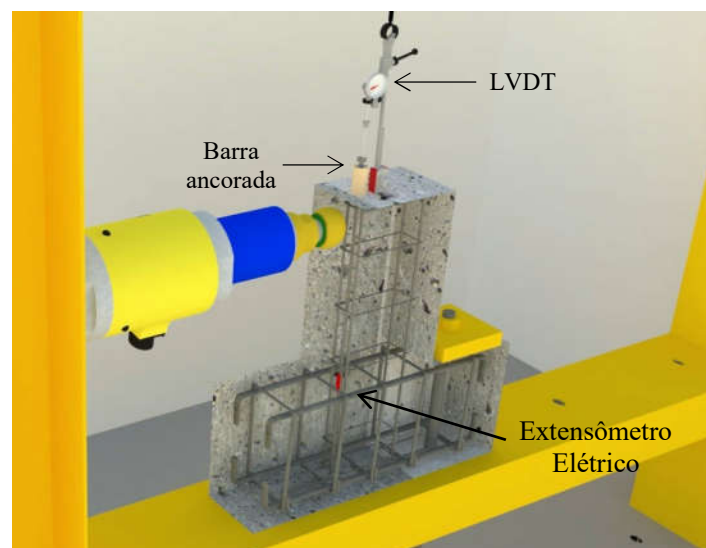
Sistema de ensaio com detalhamento da armadura das vigas.
